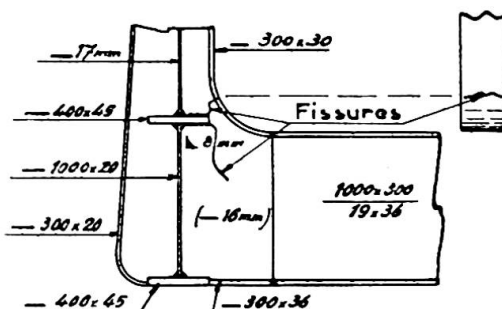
Fissuration de l'âme du raidisseur d'un montant par suite d'un mauvais parachèvement.
